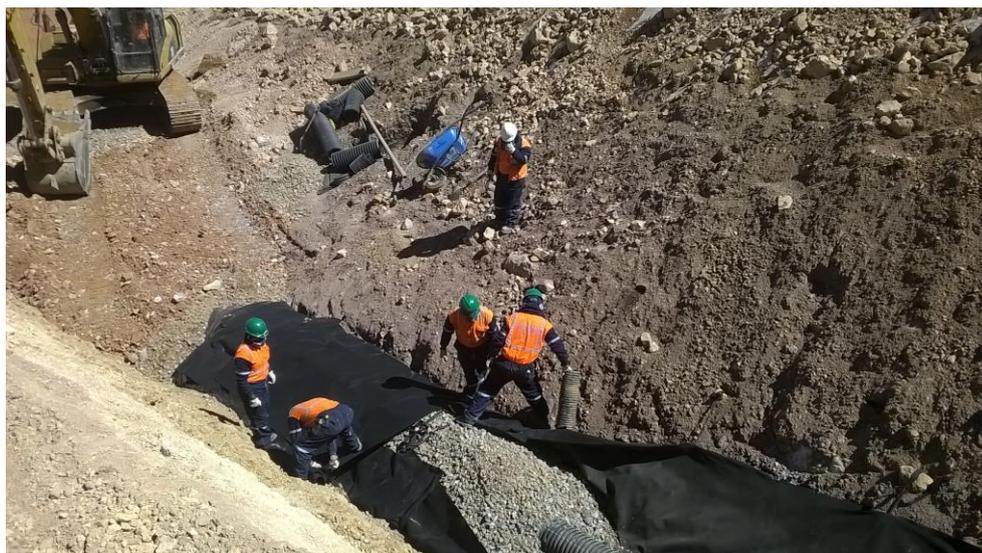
En la foto se observa la instalación del sistema de subdrenaje para la construcción PAD, Fuente: Propia
